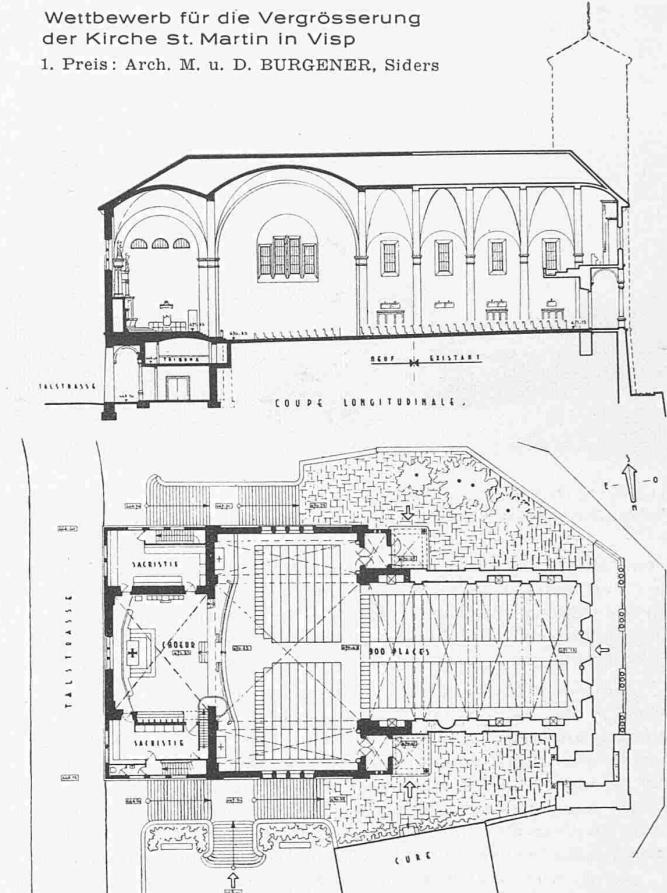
und 4. Grundriss und Längsschnitt 1:700
